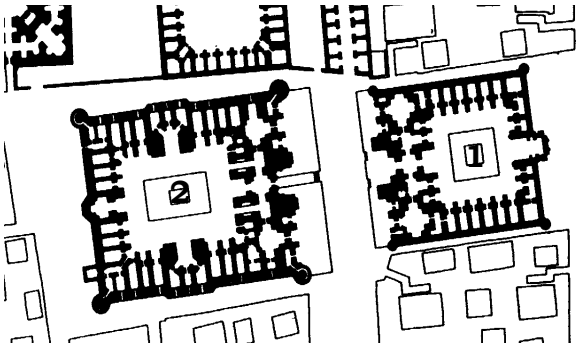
Grundriss der Ensemble aus zwei *Medresen*.
